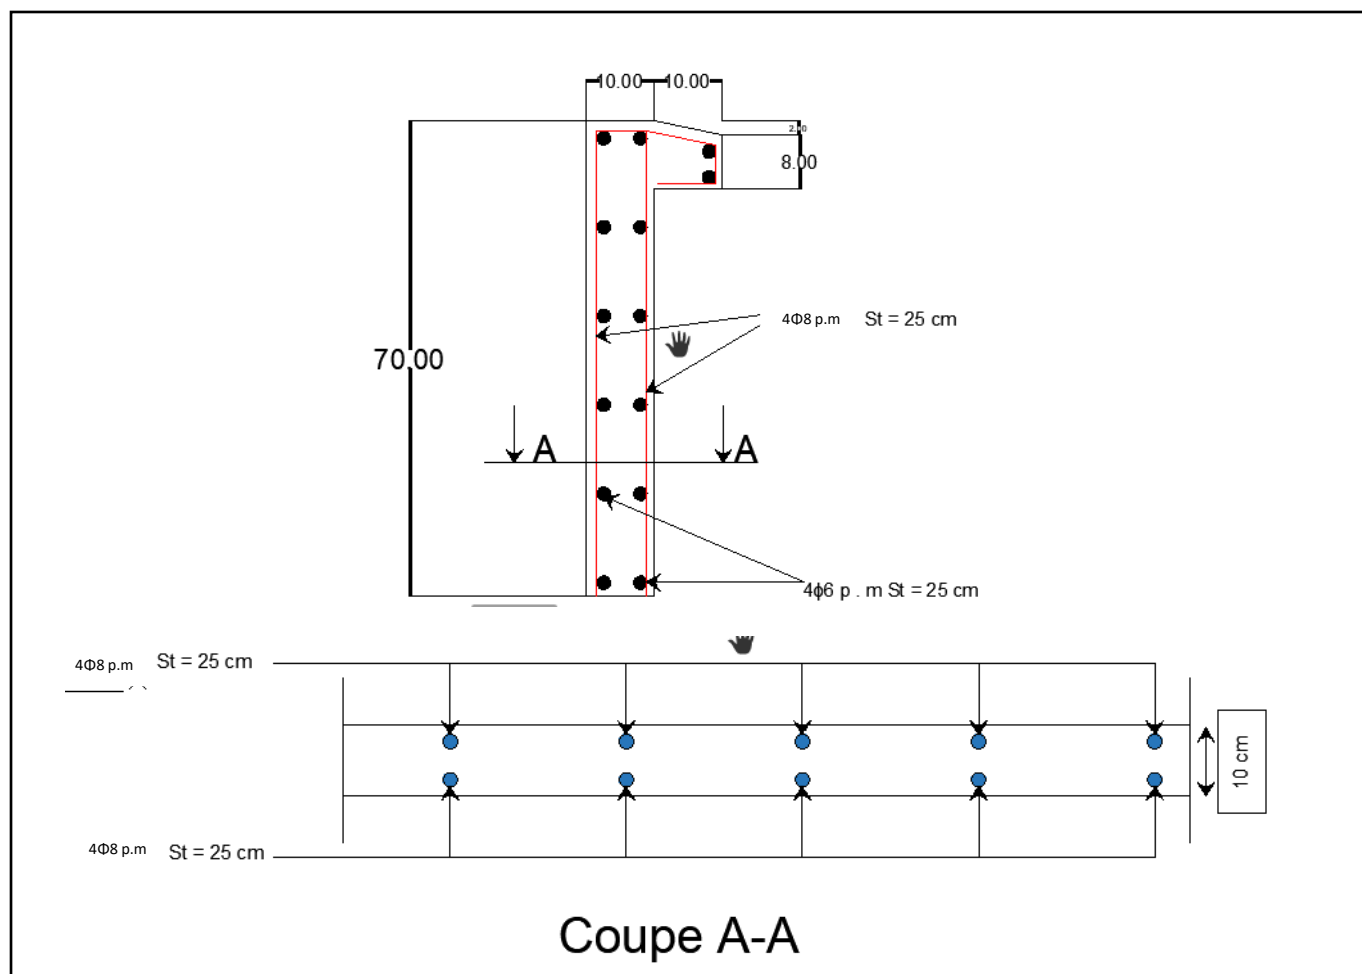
Schéma de ferrailage de l'acrotère (par autocad)
